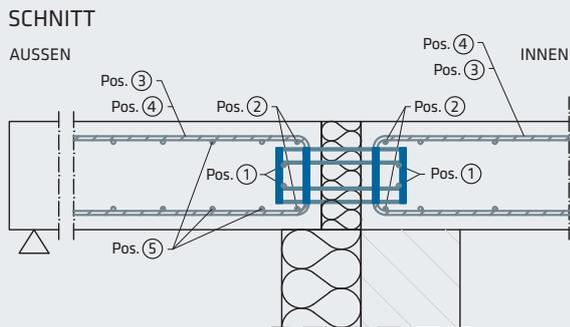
Bauseitige Bewehrung mit außen angeordneten Splintstäben
